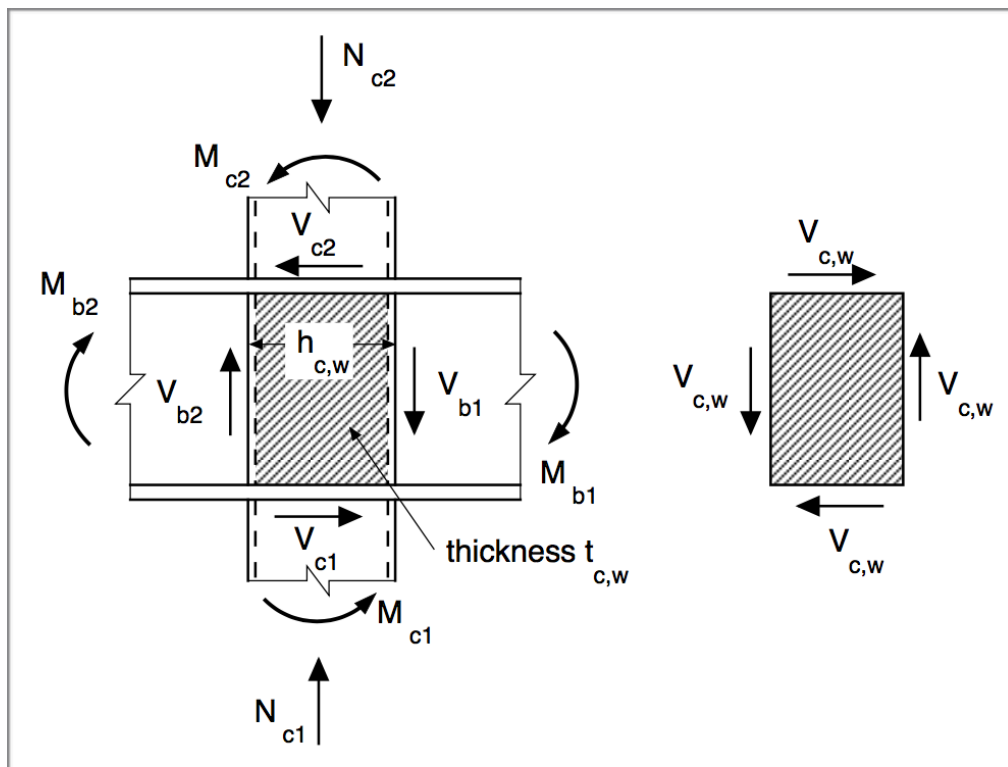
Diagrama de fuerza cortante en la zona panel. (Packer, DESIGN GUIDE FOR STRUCTURAL HOLLOW SECTION COLUMN CONNECTIONS, 2004)
